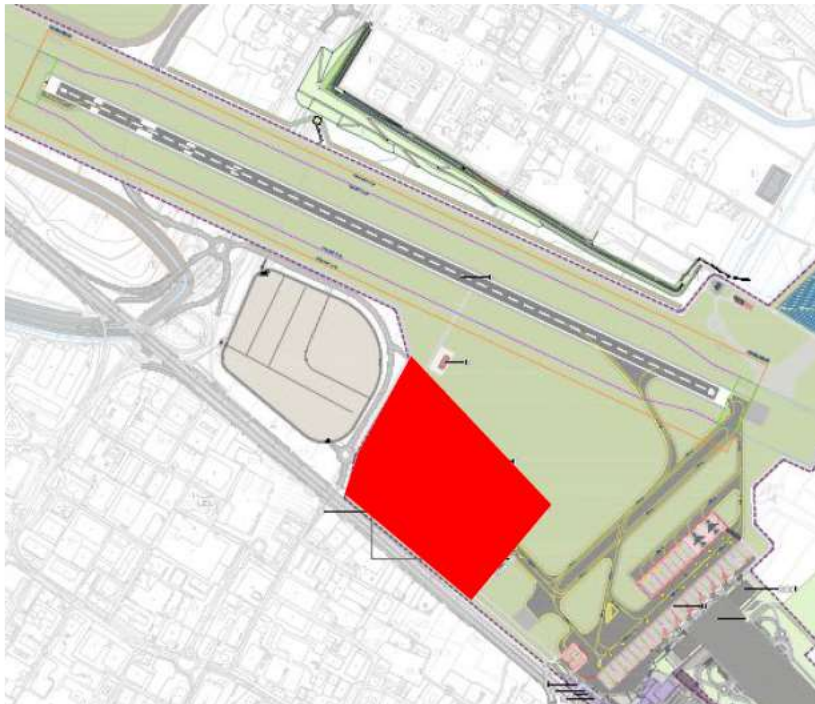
Ipotesi Masterplan con individuazione dell'area ovest
